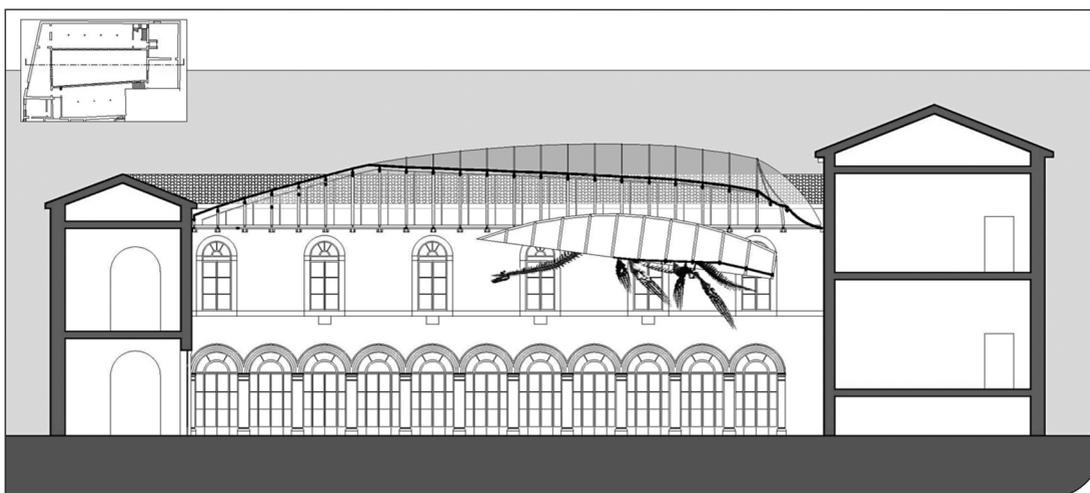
Progetto di copertura. Sezione B-B (vista prospetto est).
